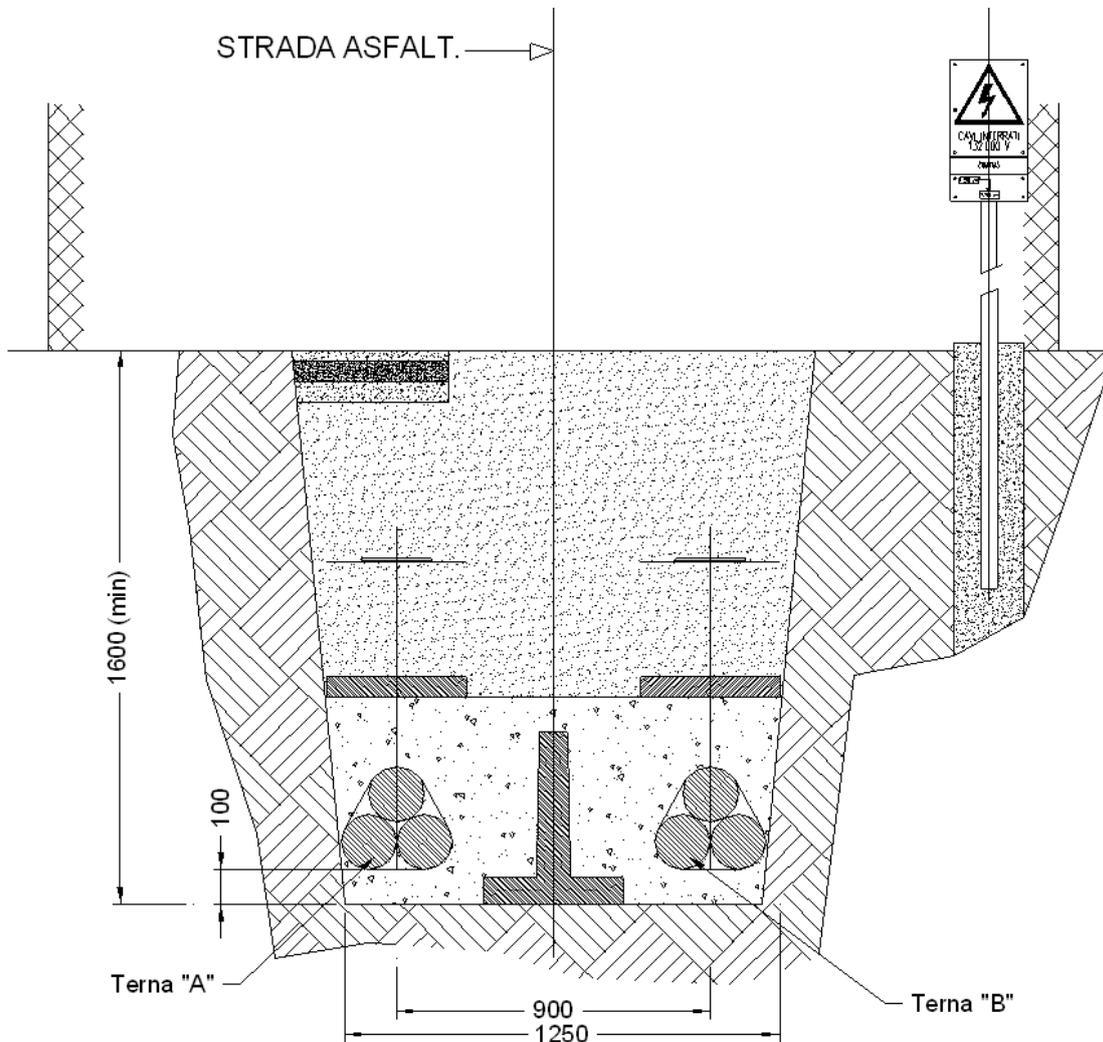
Sezione tipo “B” – Disposizione dei conduttori
